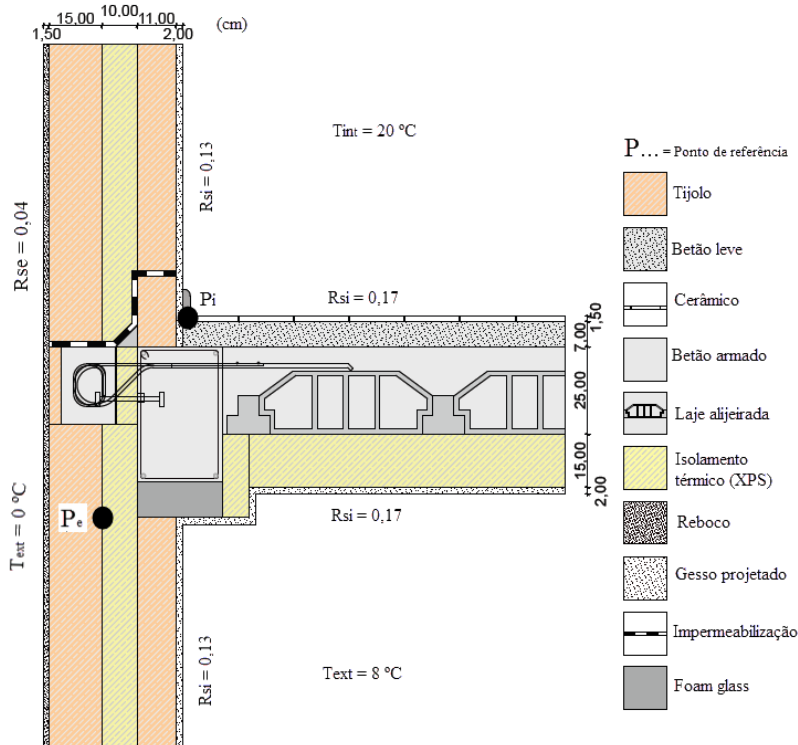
Ligação de fachada (parede dupla) com pavimentos sobre locais não aquecidos
